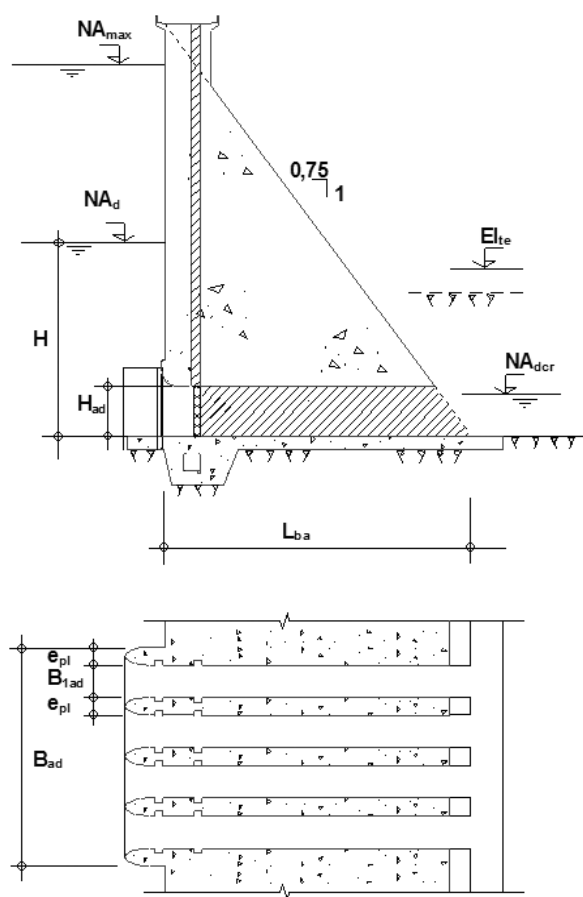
Seção típica e planta de adufas em barragem de concreto a gravidade.
